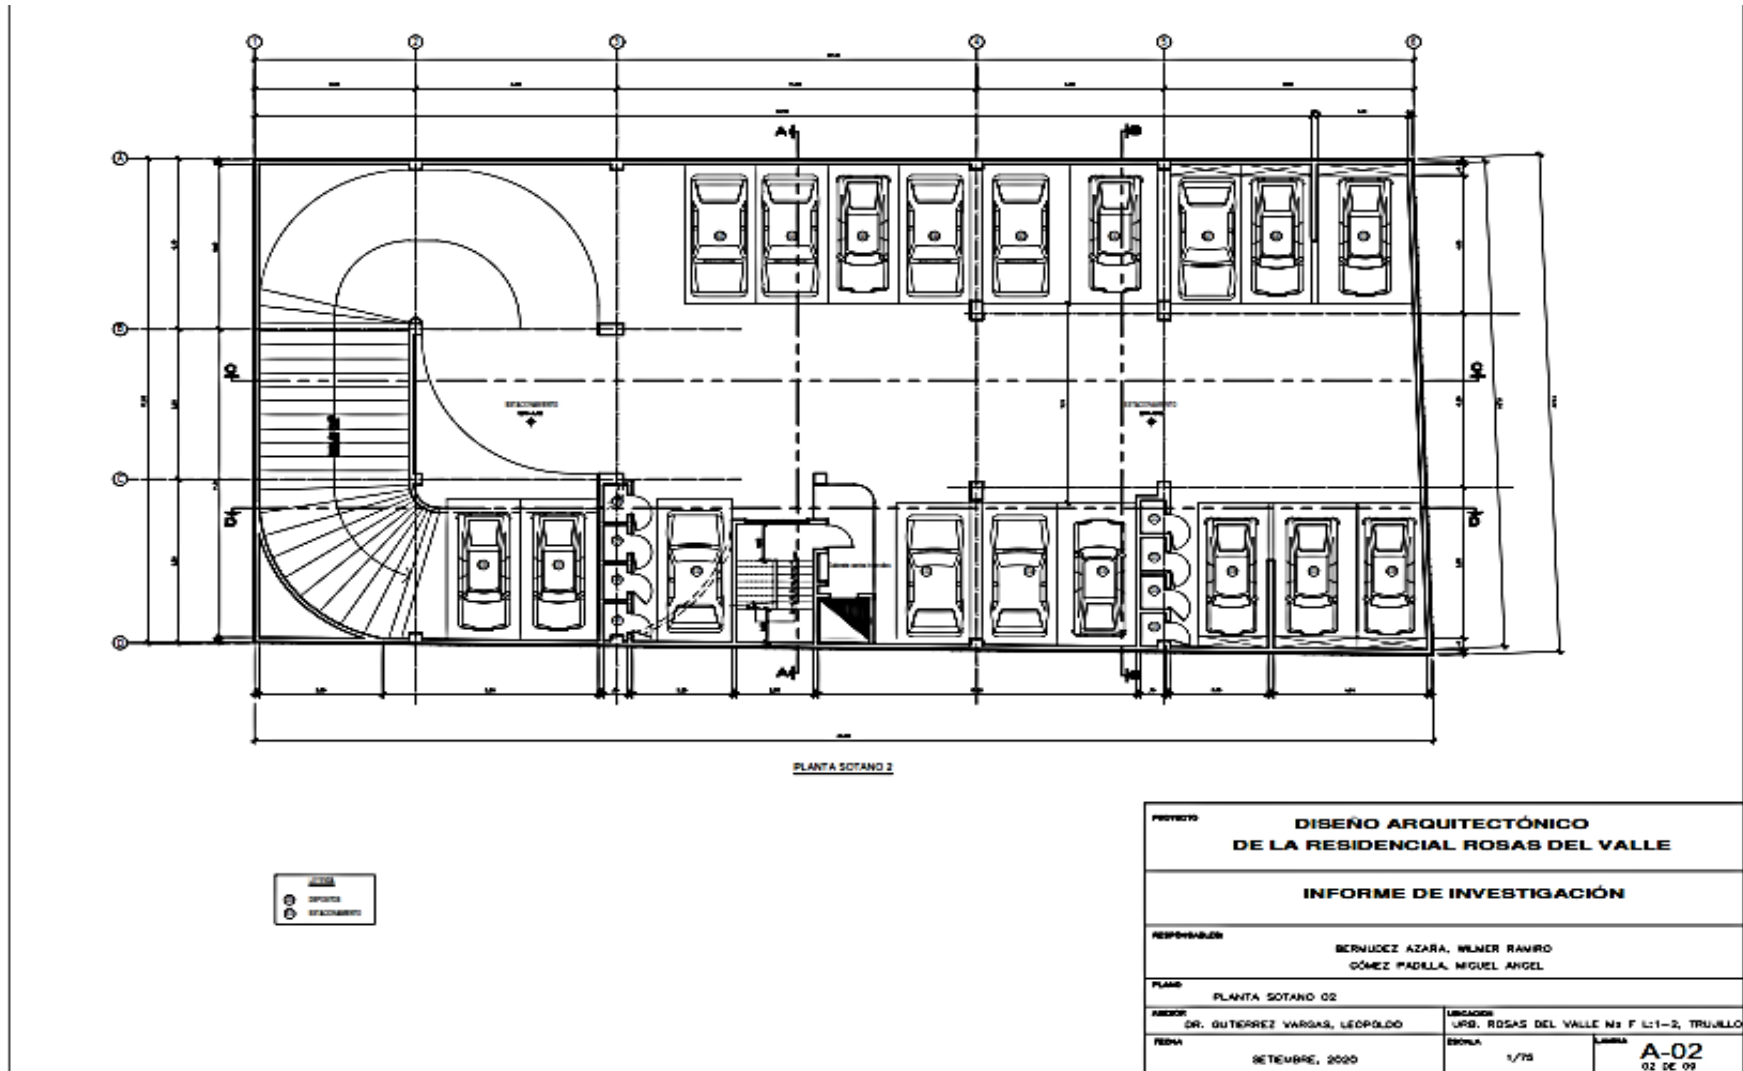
Plano de planta sótano 02. Fuente: Elaboración propia
